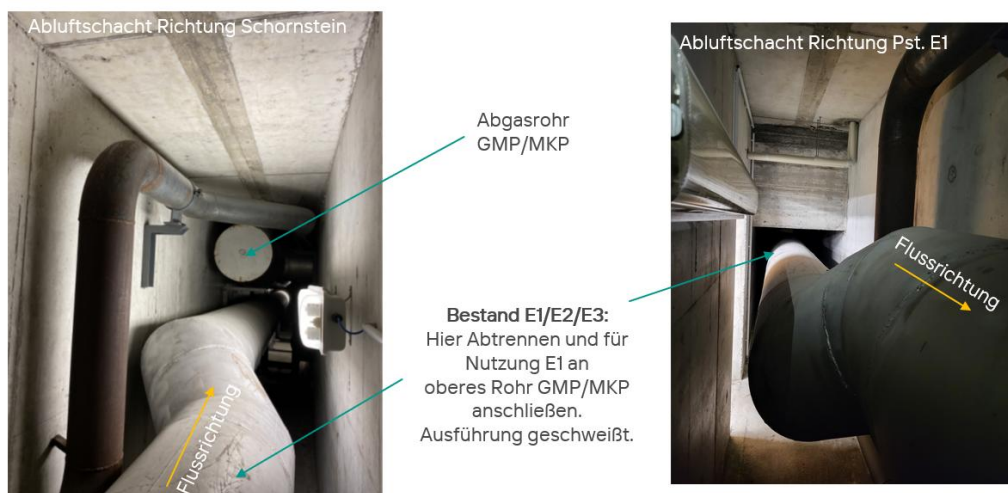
Detail Umschluss Abgasführung Strang 1n E-Seite
